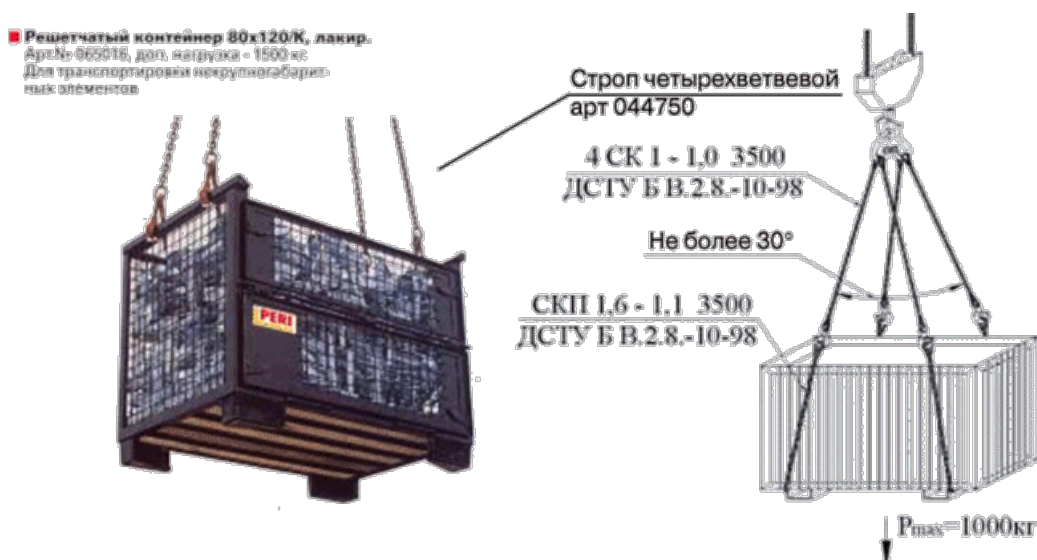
Схема строповки контейнера для подачи мелких деталей
